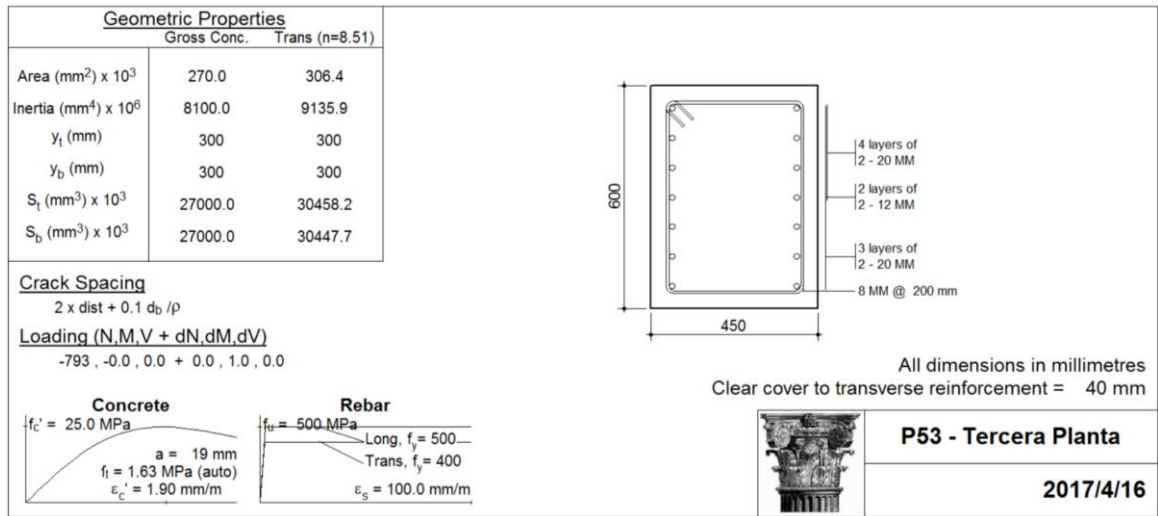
Datos del pilar 53 en tercera planta (Ref. [6])
